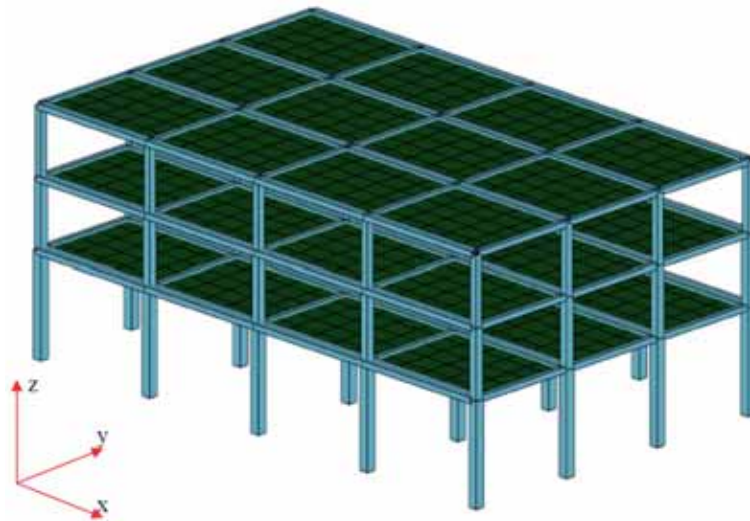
Perspectiva del edificio porticado de vigas planas y forjado unidireccional.
